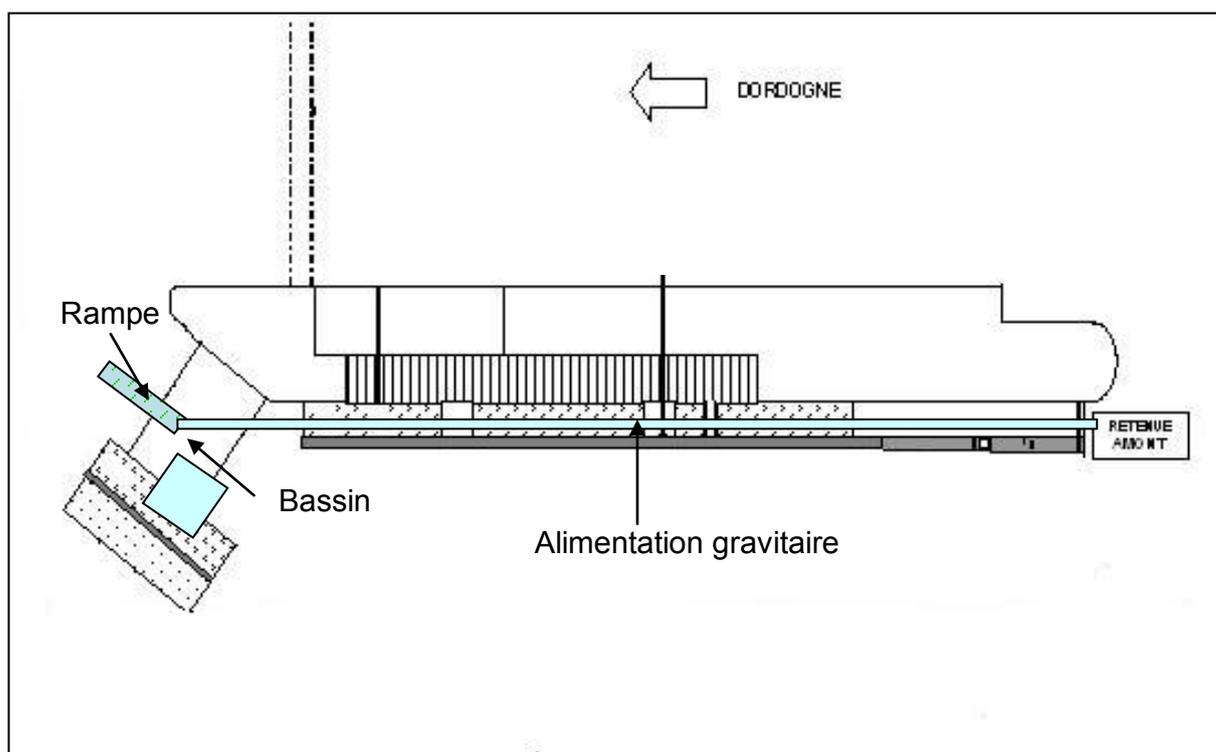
Schéma de situation de la passe provisoire installée en 2009 sur le site de Tuilières
